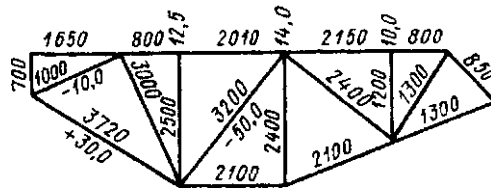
Нанесение размеров на геометрической схеме металлоконструкций
